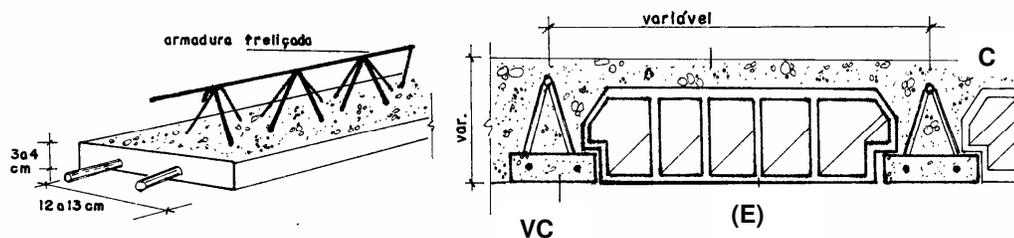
Elementos de uma laje pré-fabricada treliça
